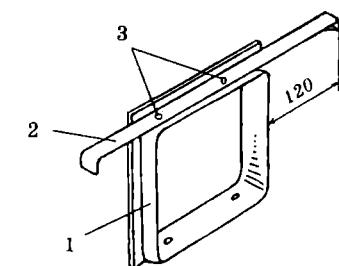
Крепление кляммеры к рамке топочной дверки:
